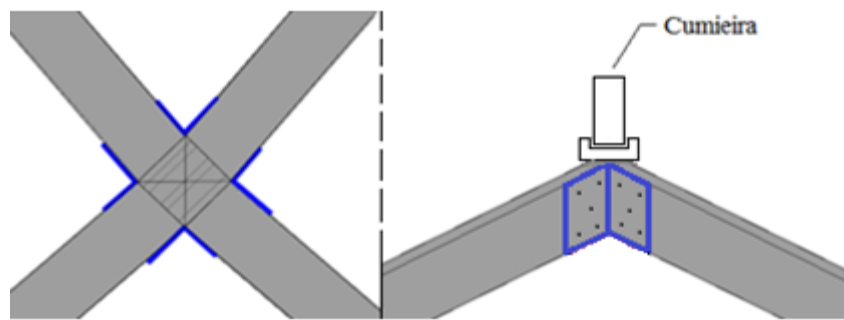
Ilustração da ligação dos quatro rincões (à esquerda vista em planta, e à direita vista frontal)
